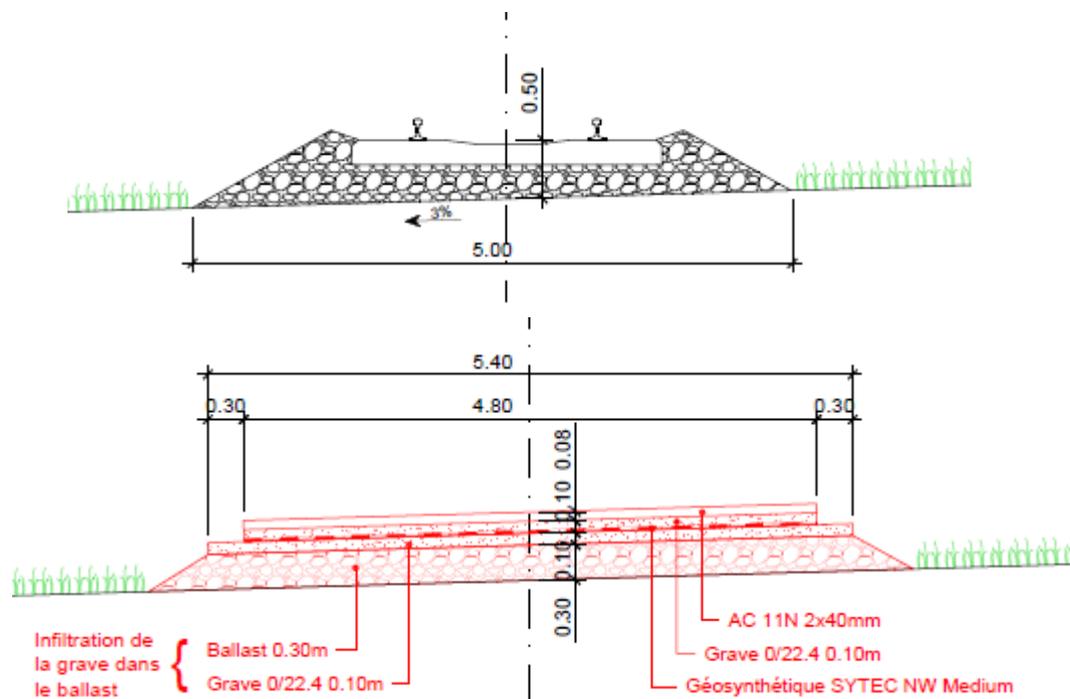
Coupes-typiques de l'infrastructure CFF actuelle (en haut) et de la future voie verte (en bas)
